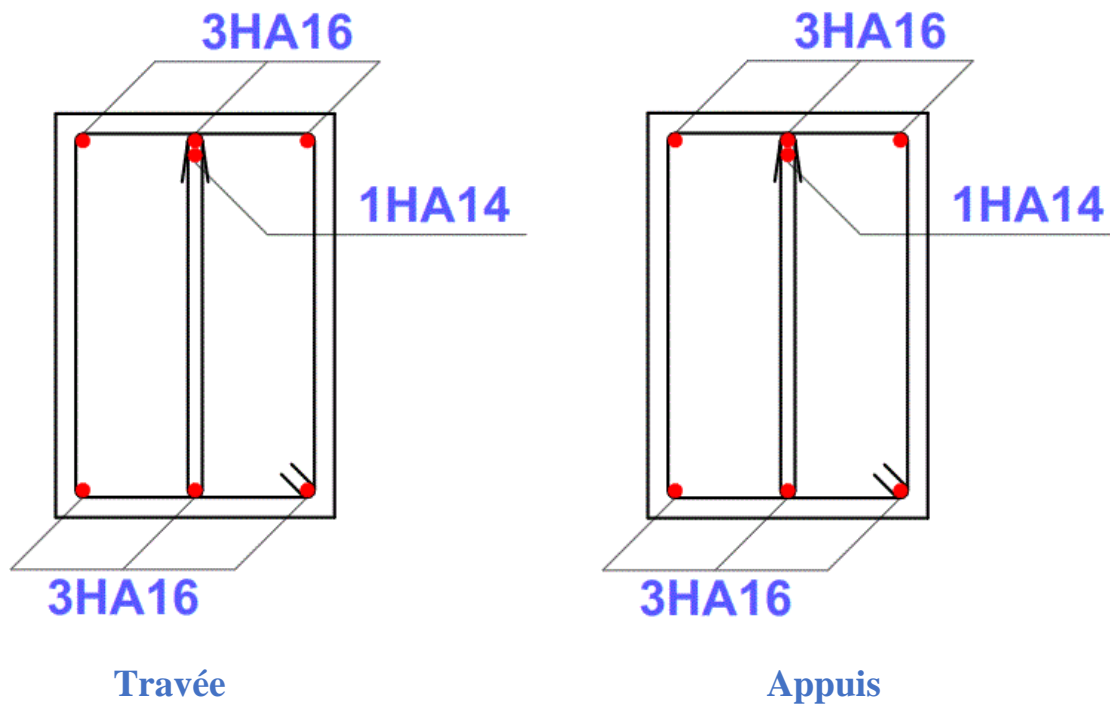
Schéma de ferrailage de la poutre secondaire du plancher de tous les niveaux
